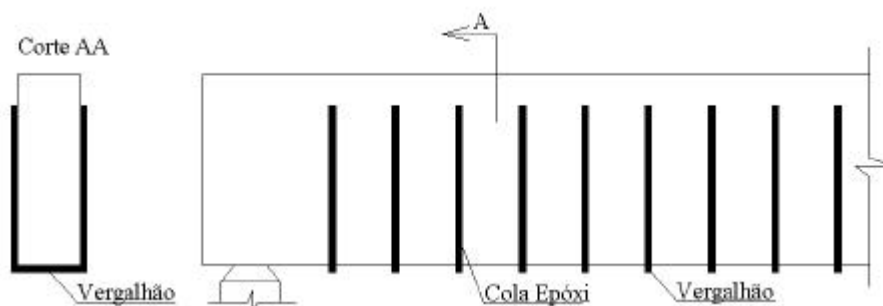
6 – Viga reforçada à flexão e cisalhamento com o uso de vergalhões colados
